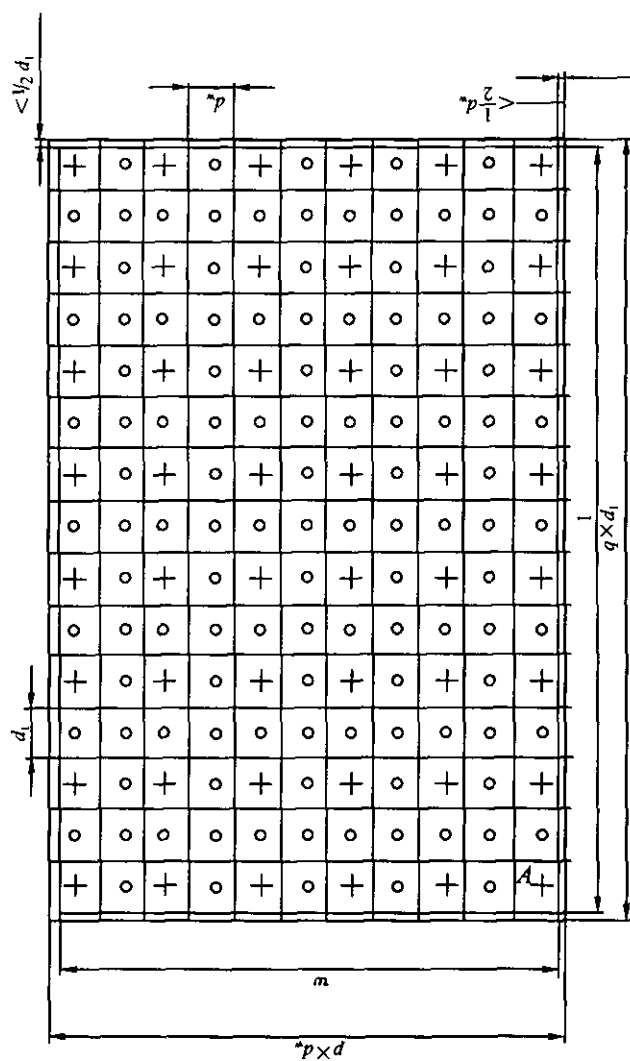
矩形场地照度计算和测量网格点布置图
